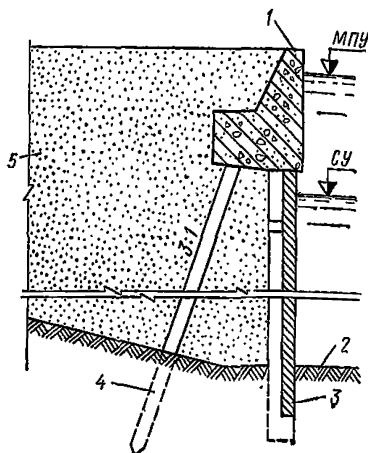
Стена из железобетонного таврового или прямоугольного шпунта с наклонными анкерными сваями
